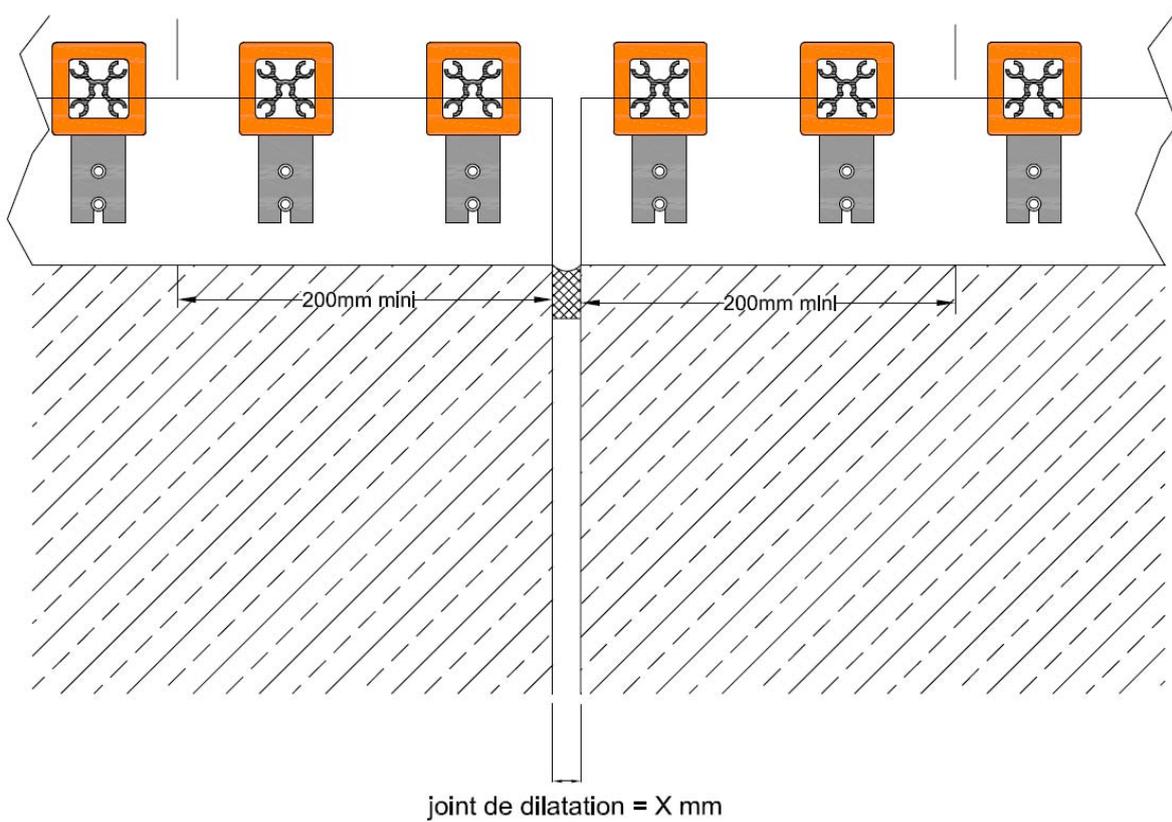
b – Pose verticale, joint de dilatation avec Barro-fix
